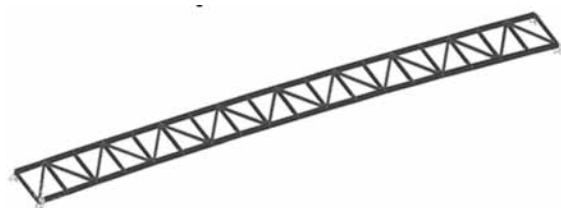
Detalle de Modelo de elementos finitos de tablero
